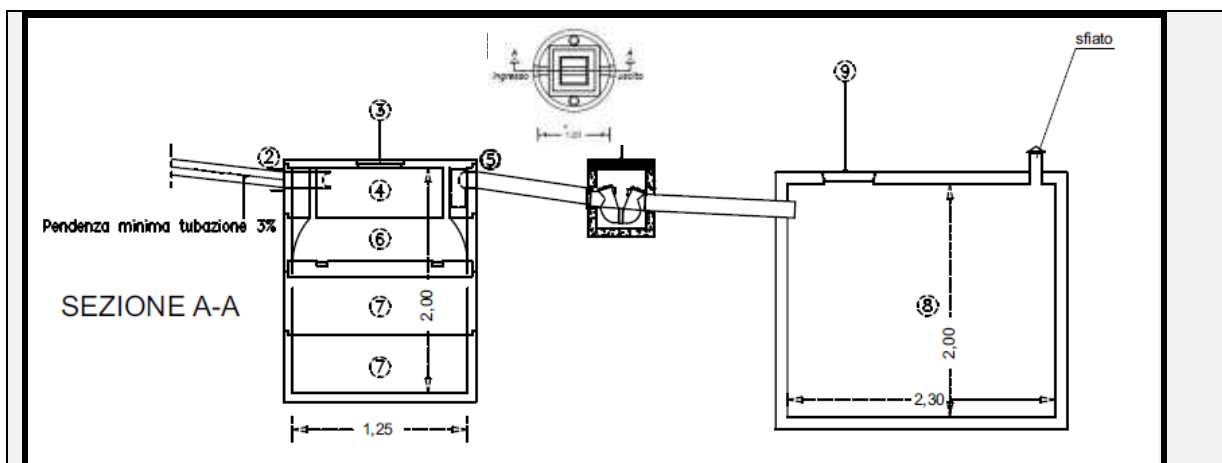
Sezione schematica impianto smaltimento reflui.
